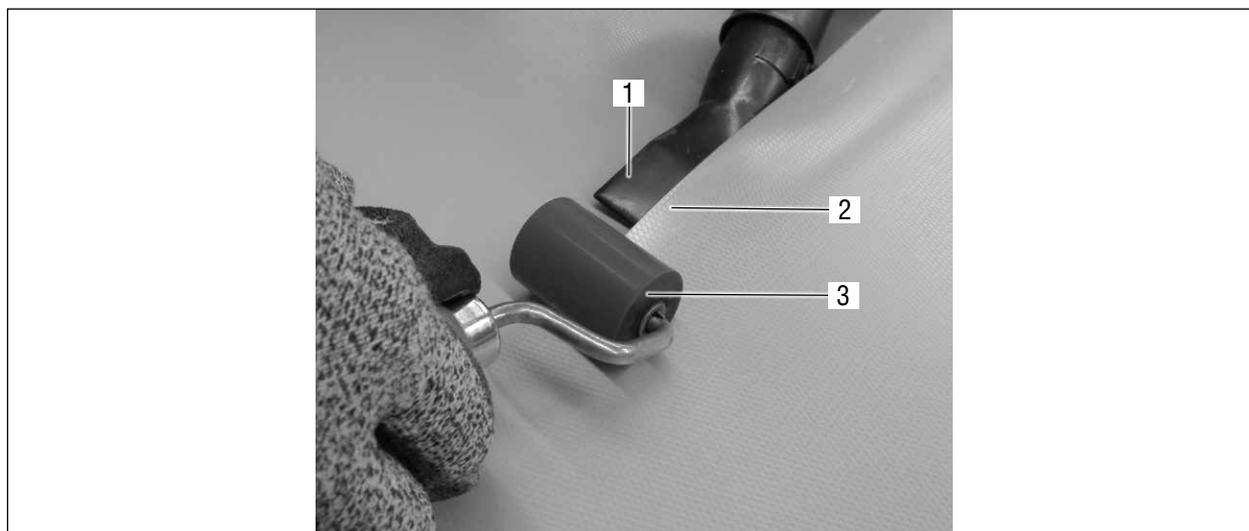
Sigillatura della membrana per tetto mediante saldatura ad aria calda
